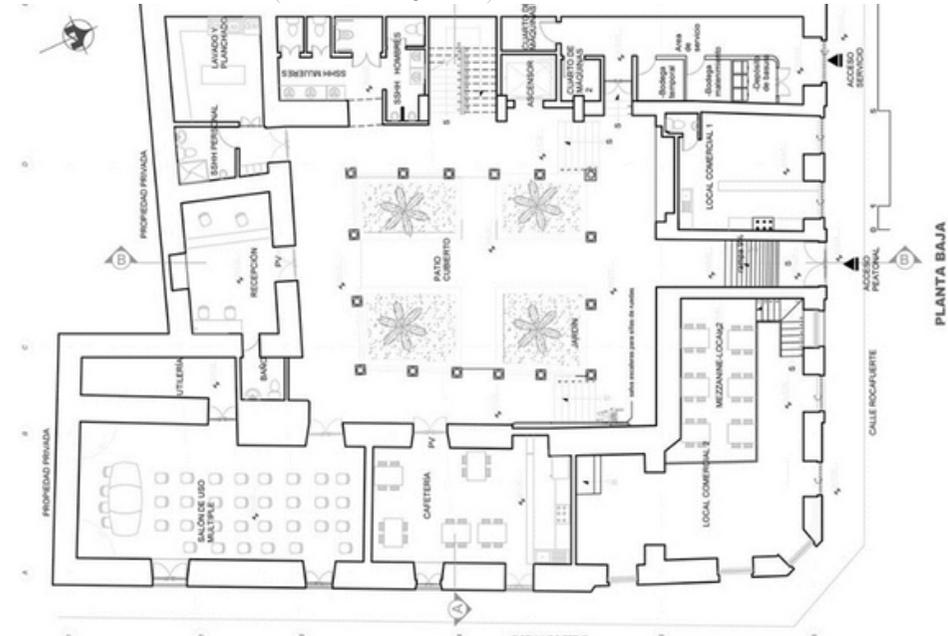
Planta Nivel 1 del Hotel Alqvimia
